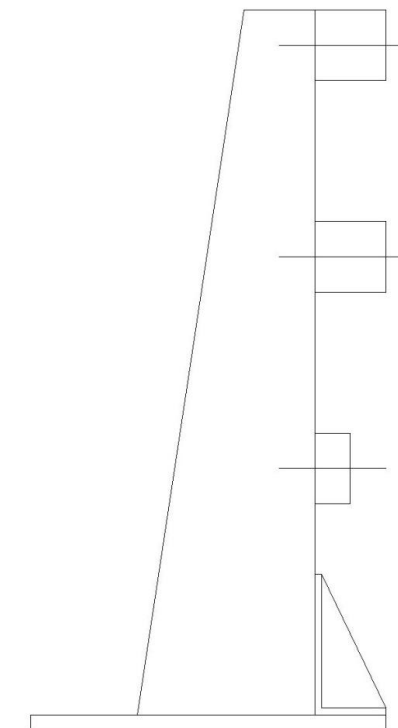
Defensa lateral. Pretel metálico PMC2/10b
